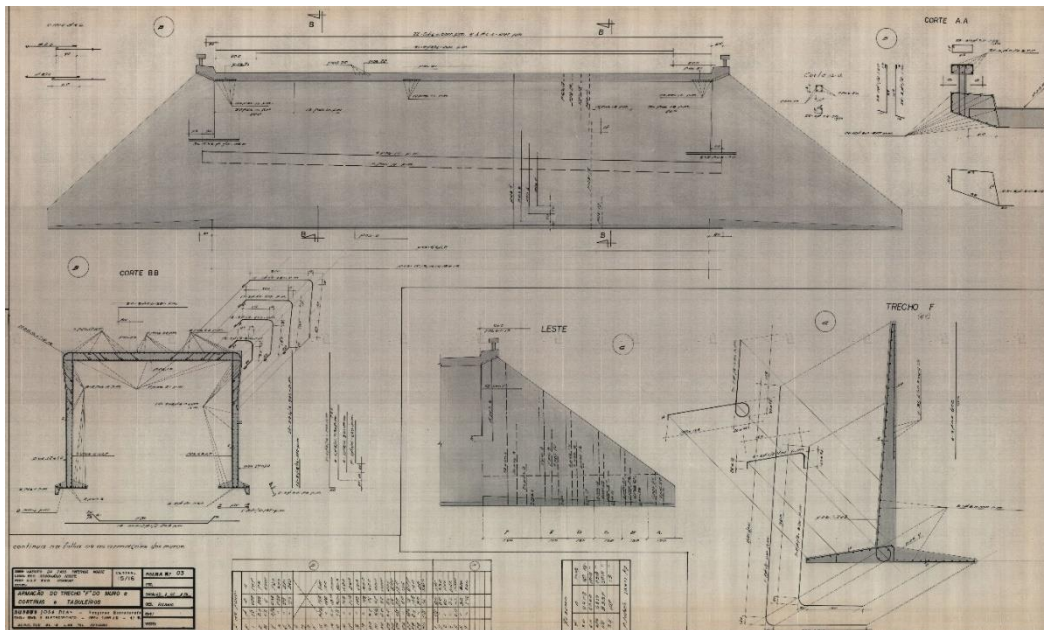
Ilustração da Planta de Armação – Viaduto Central 15/16 Norte Eng. Rubens José Dias – 1979 (ARQUIVO PÚBLICO DE BRASÍLIA)
